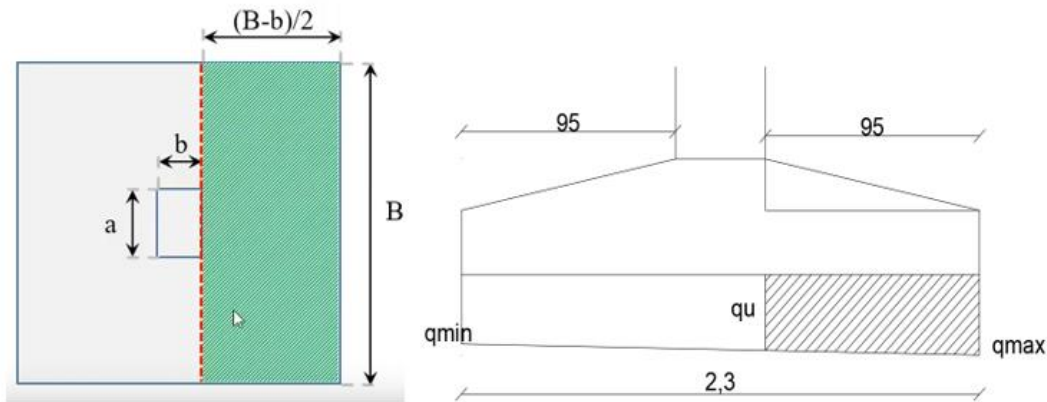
Sección crítica para flexión. (elaboración propia)
